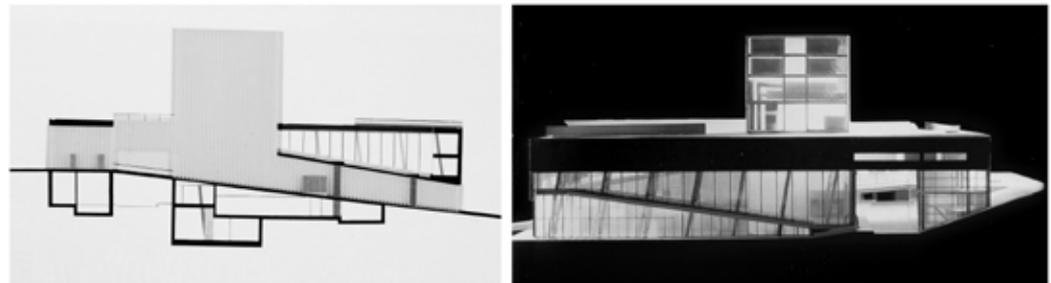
| Sección Norte-Sur y Maqueta. Kunsthall, Rotterdam.
